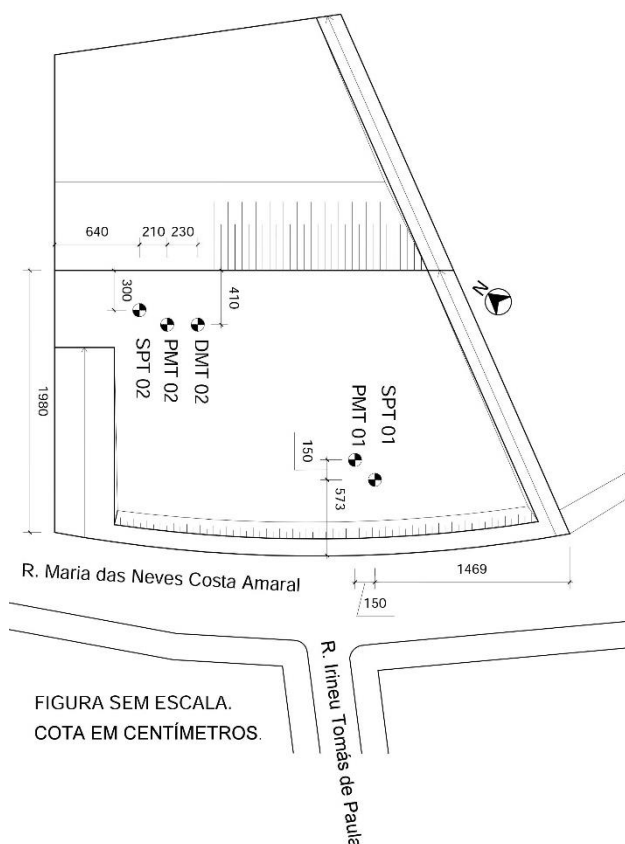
Croqui esquemático da localização das sondagens (fonte: autores).
